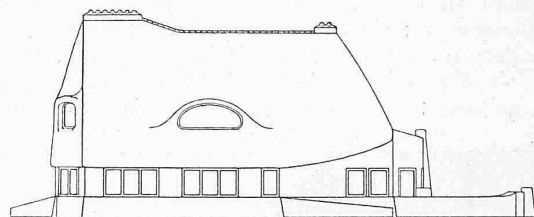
und 30. Grundrisse und Aufriss zu Abb. 23. — Etwa 1 : 300.
